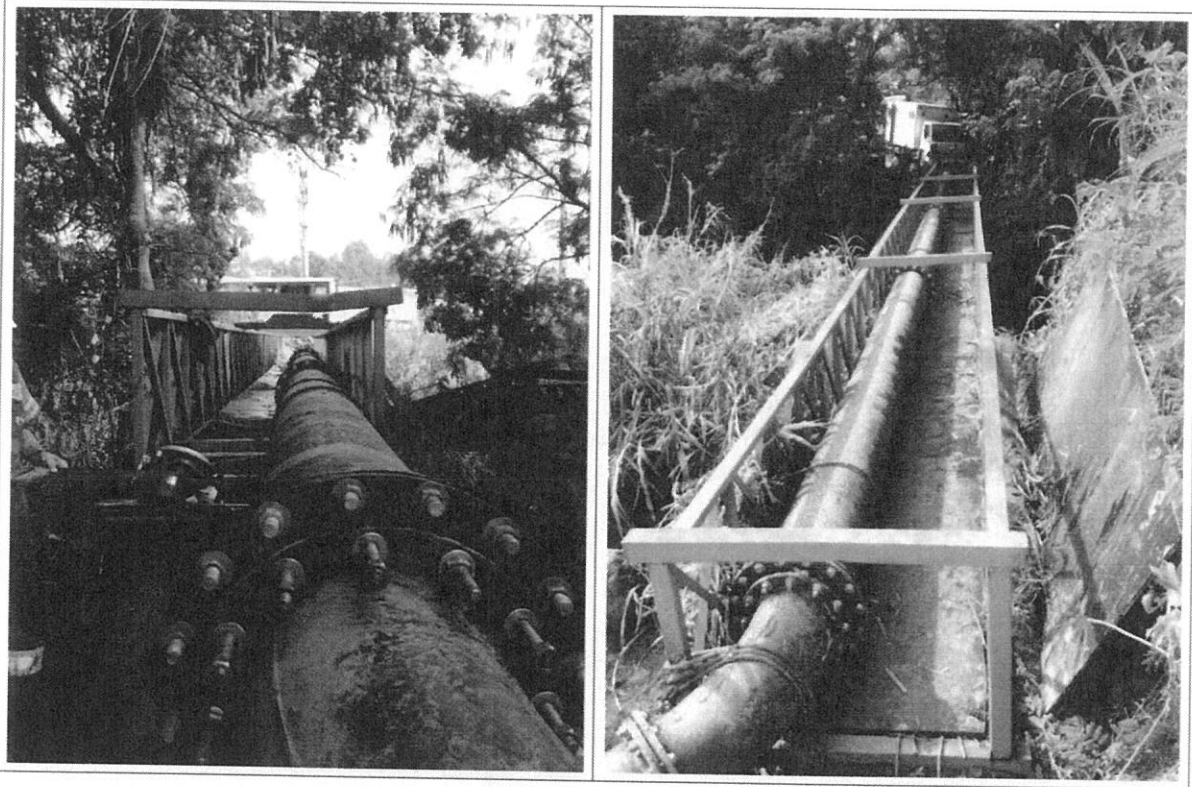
Vista da nova travessia executada em ferro fundido flangeado de 400 mm de diâmetro, sobre a nova treliça.
